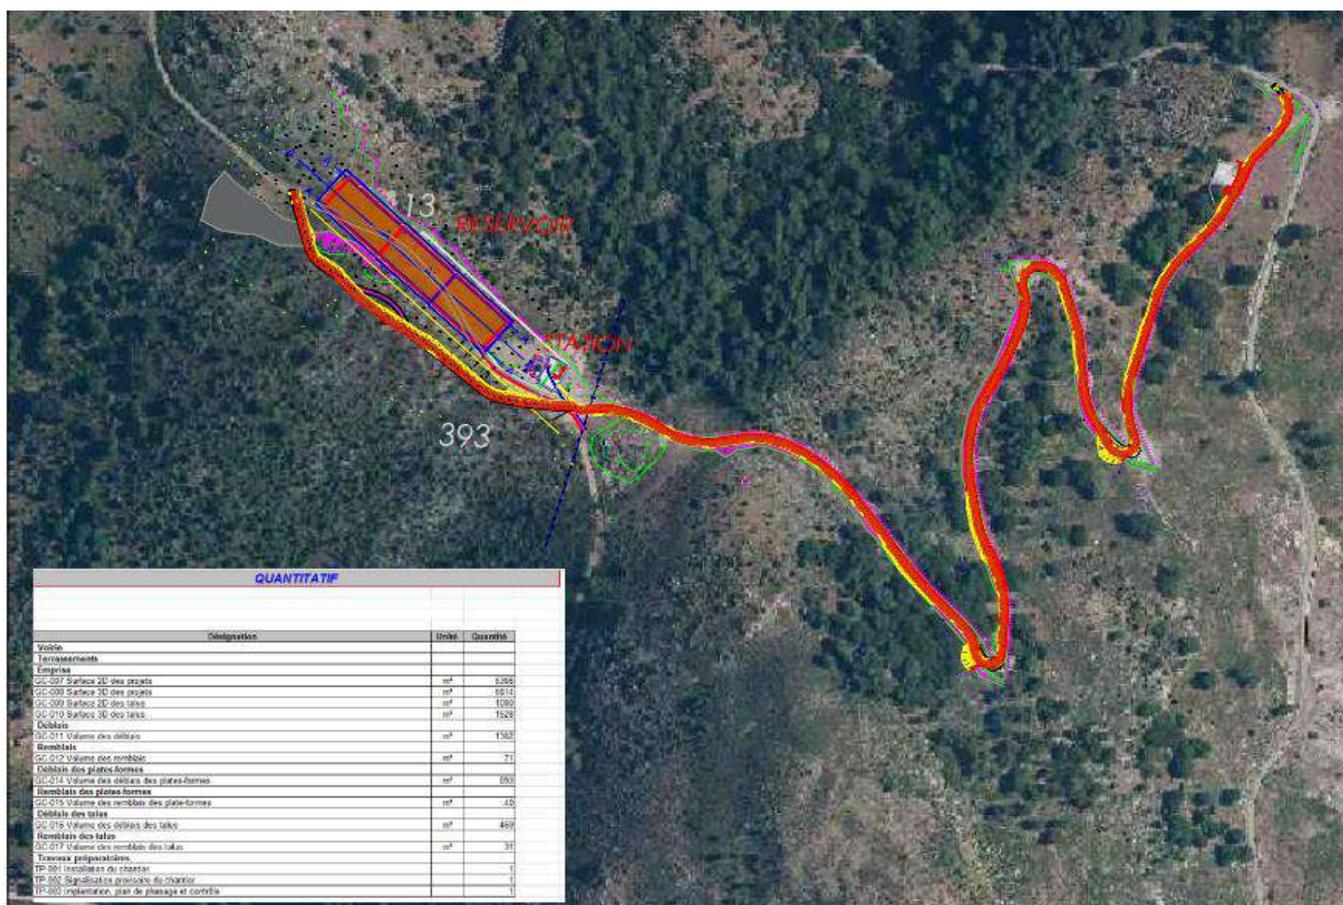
Projet de reprofilage de la piste d'accès au site des travaux
